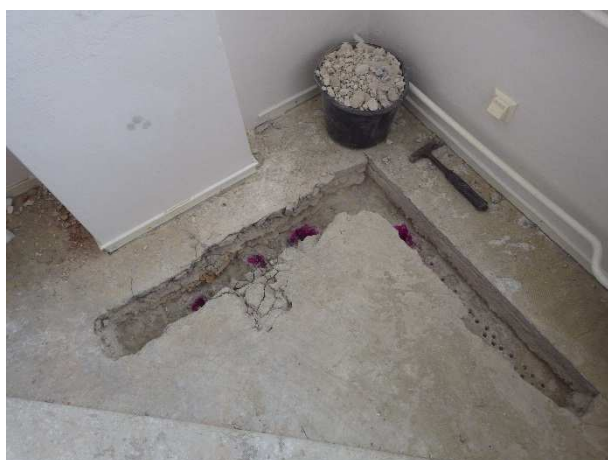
, 53 – sonda NV 12 – 4.NP- m.č. B417 – celkový pohled a detail výztuže; zk. karbonatace
